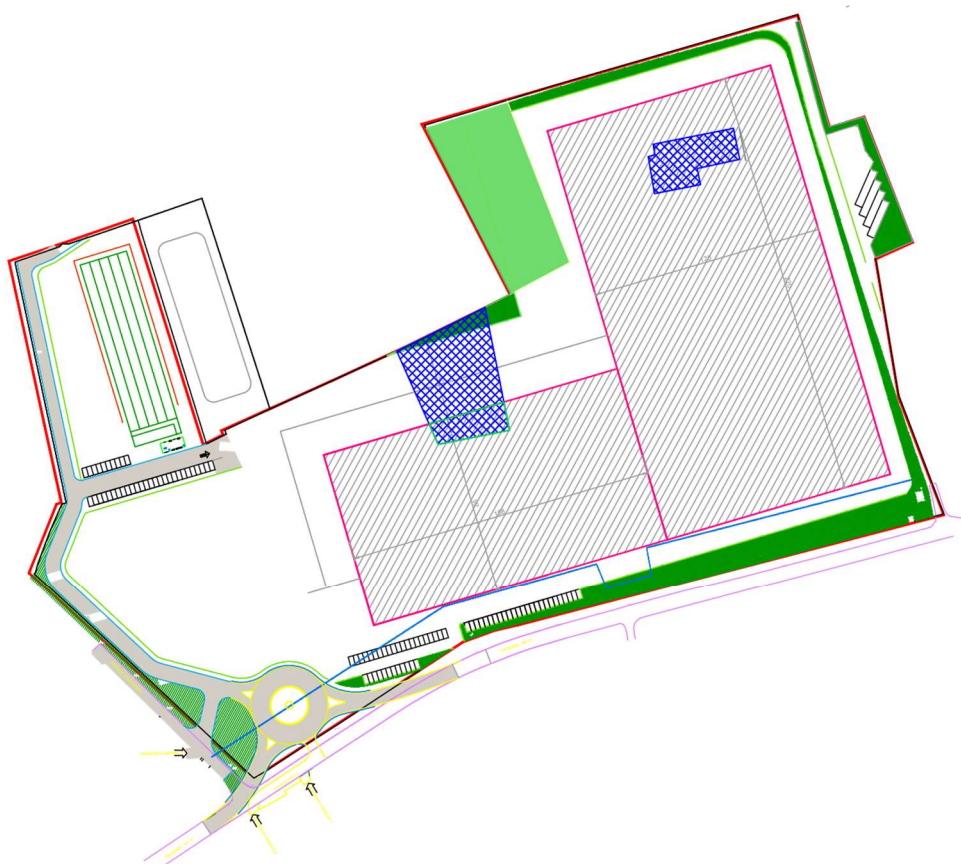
Planimetria di progetto e sovrapposizione alle aree 17 e 25 caratterizzate dall'intervento di capping identificate dal retino blu
